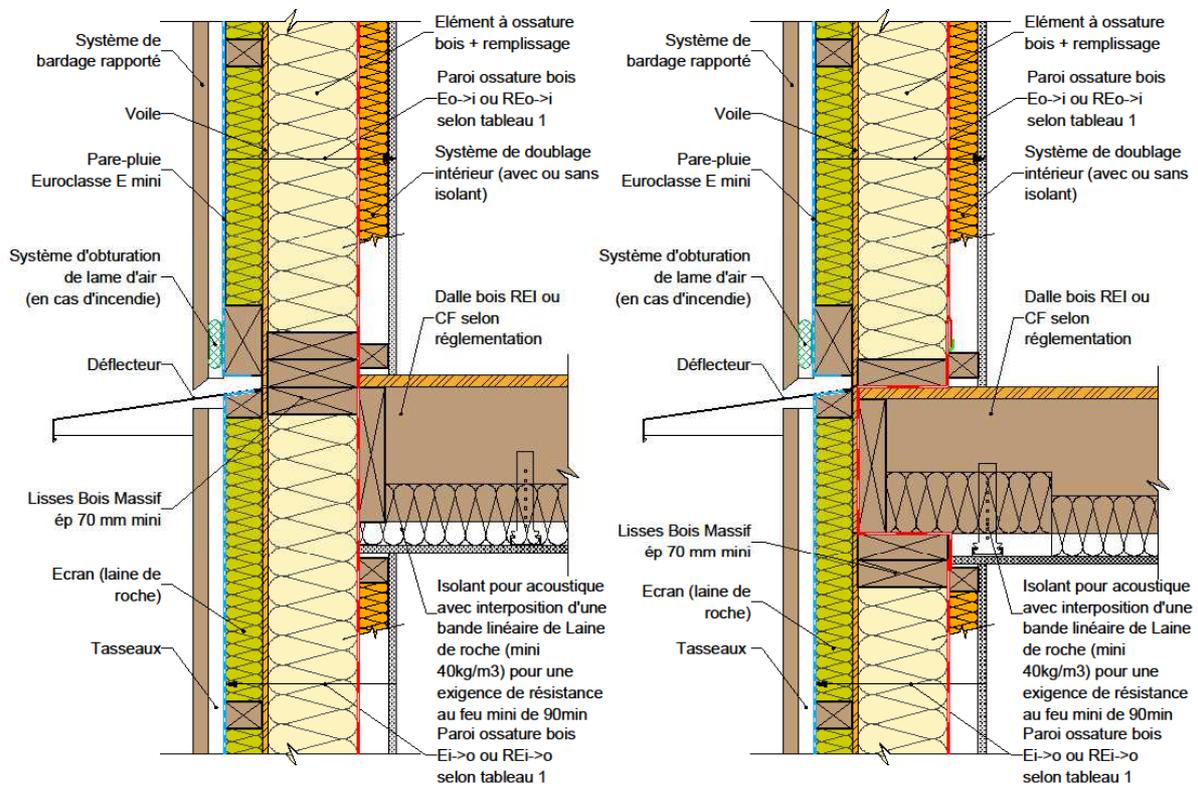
Façade/mur ossature bois & plancher en ossature bois.
